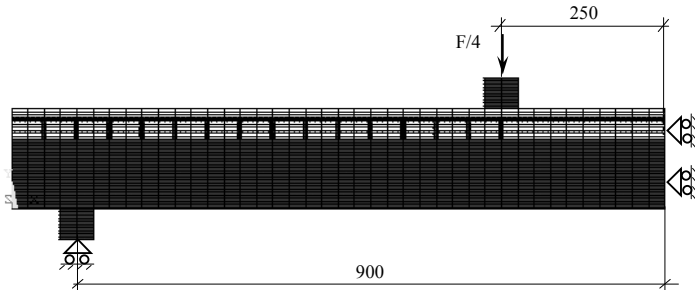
Схема навантаження СЕ моделі підсиленої залізобетонної балки
